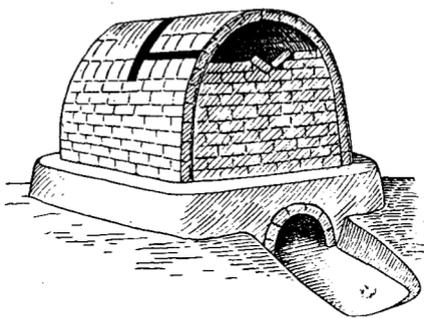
Общий вид наземной конструкции горна закрытого типа
